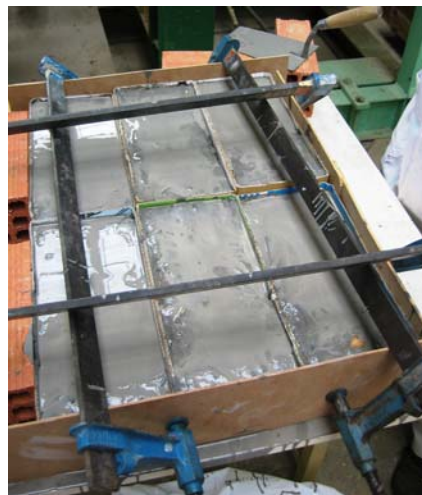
Detalle de las seis probetas obtenidas de tres adobes previamente a su ensayo.
